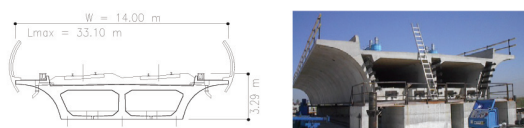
Impalcato a monocasone bicellulare in c.a.p. (viadotto Piacenza). *Pre-stressed reinforced concrete single box bi-cellular deck (Piacenza Viaduct)*.
